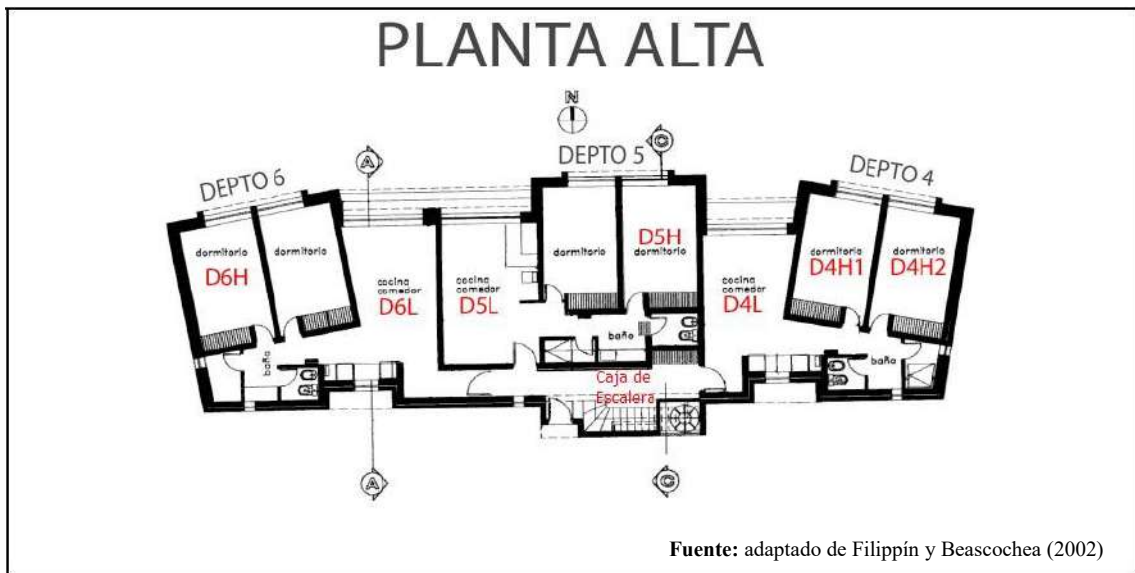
Disposición de los sensores en los departamentos de planta alta
